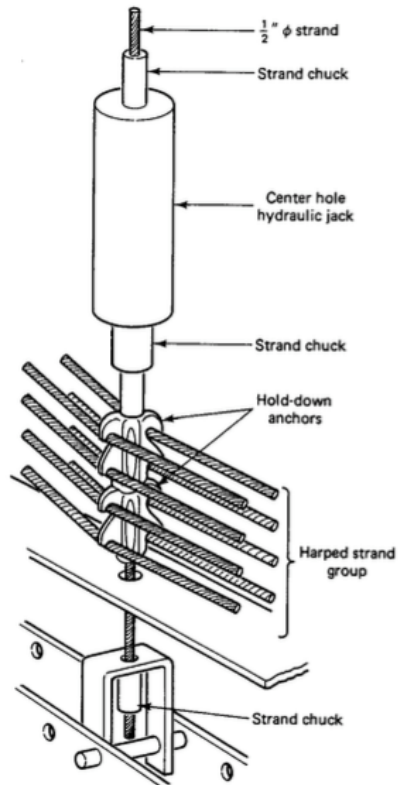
Anclaje para mantener los tendones en la parte baja de la viga¹⁹
